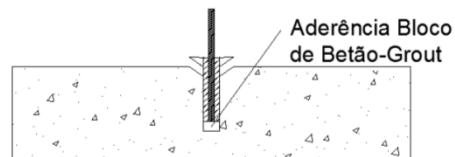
Rotura por aderência entre o Bloco de Betão e o Grout
